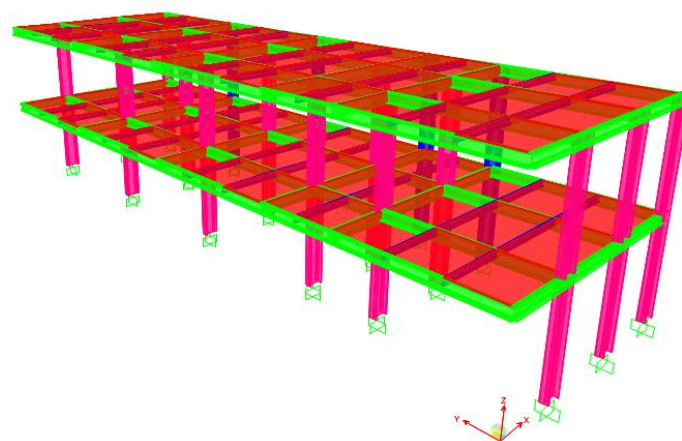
Modelamiento de bloque 2 – acero estructural
